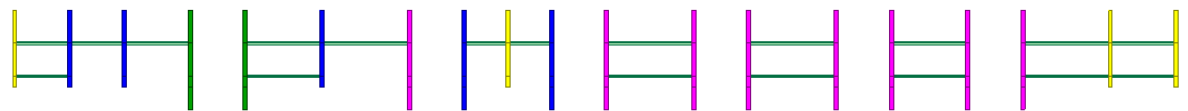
Prospetto della barriera 4.50m - tratto est da M246 a M228
